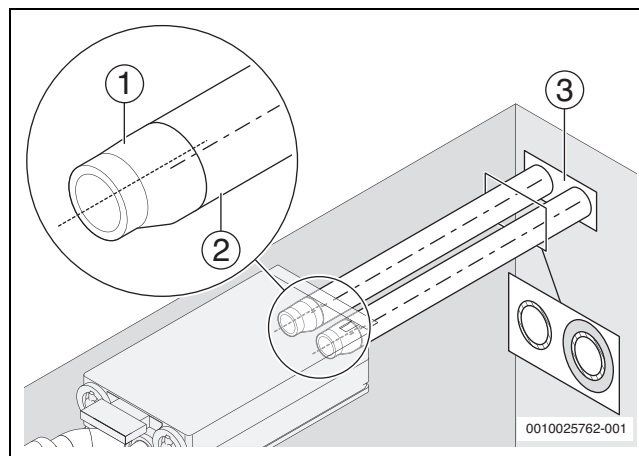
Anschlussdetails zu Bild 39: Rohrführung Außen-/Fortluftleitung
